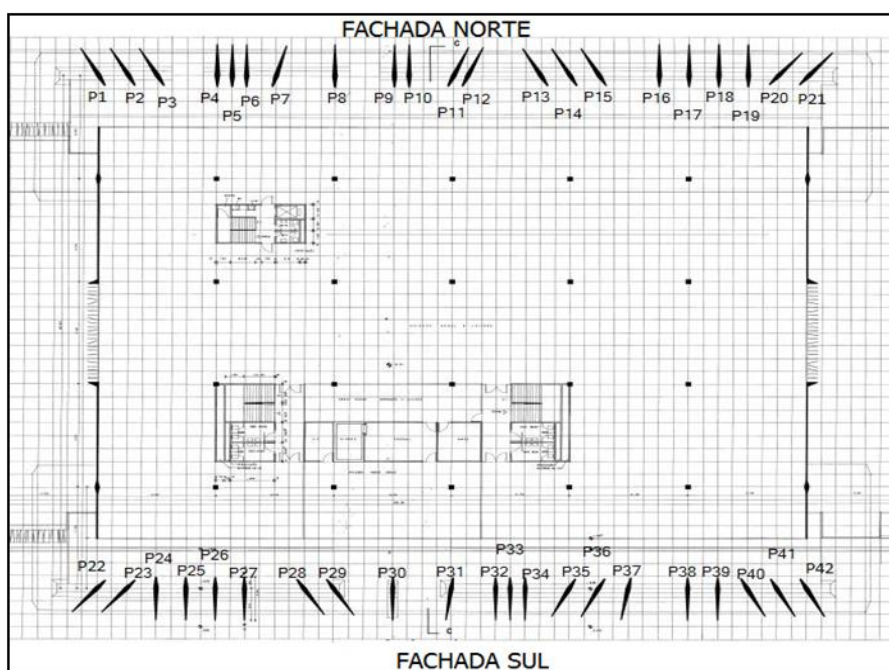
Planta baixa com destaque aos pilares e sua nomenclatura.
